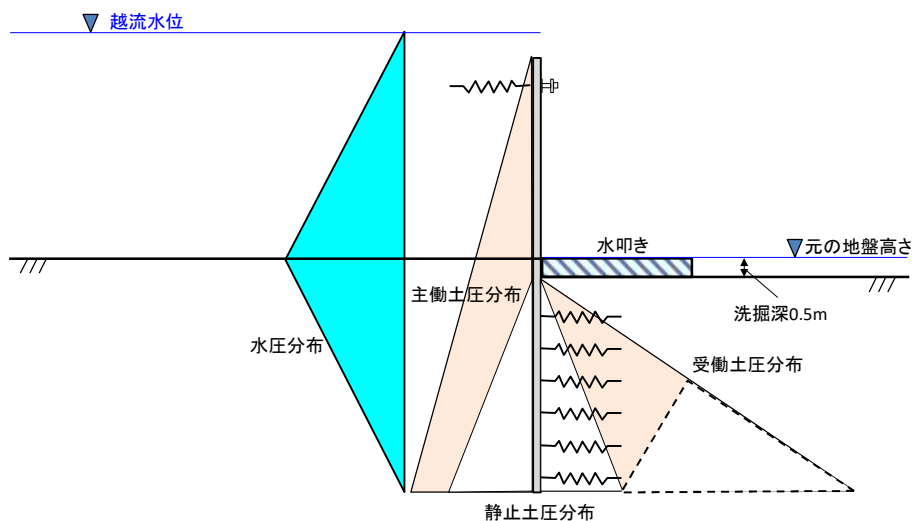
鋼矢板の曲げ破壊に対する検討モデル
